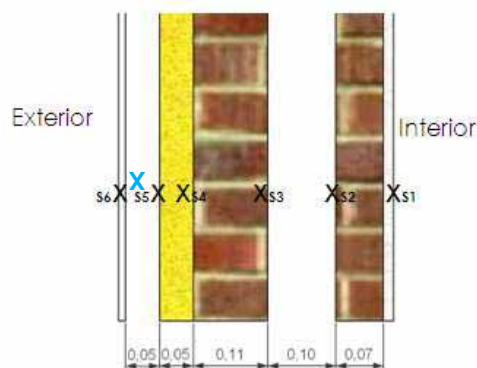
Sección representativa de la solución de muro base y fachada ventilada de junta abierta ejecutada. Ubicación de los sensores superficiales en cada uno de los cuatro ejes de medida de la fachada oeste de Kubik.
